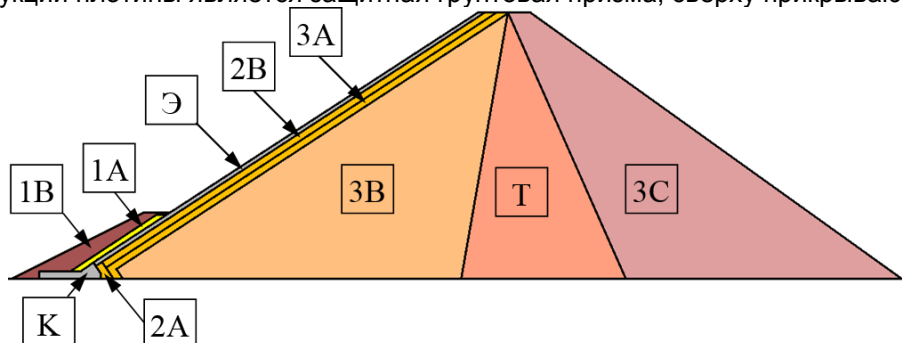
Схема современной конструкции каменно-набросной плотины с железобетонным экраном (на скальном основании) Э – железобетонный экран; К – контурная плита; 1А, 1В – составные части защитной призмы; 2В, 2В – составные части подэкрановой зоны; 3А – промежуточная зона упорной призмы; 3В, 3С, Т – соответственно верховая, низовая и средняя зоны упорной призмы.
